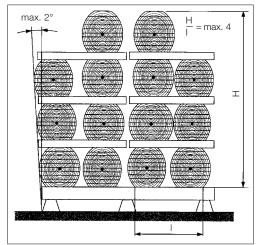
hauteur d'empilage à ne pas dépasser pour les piles de bois.
